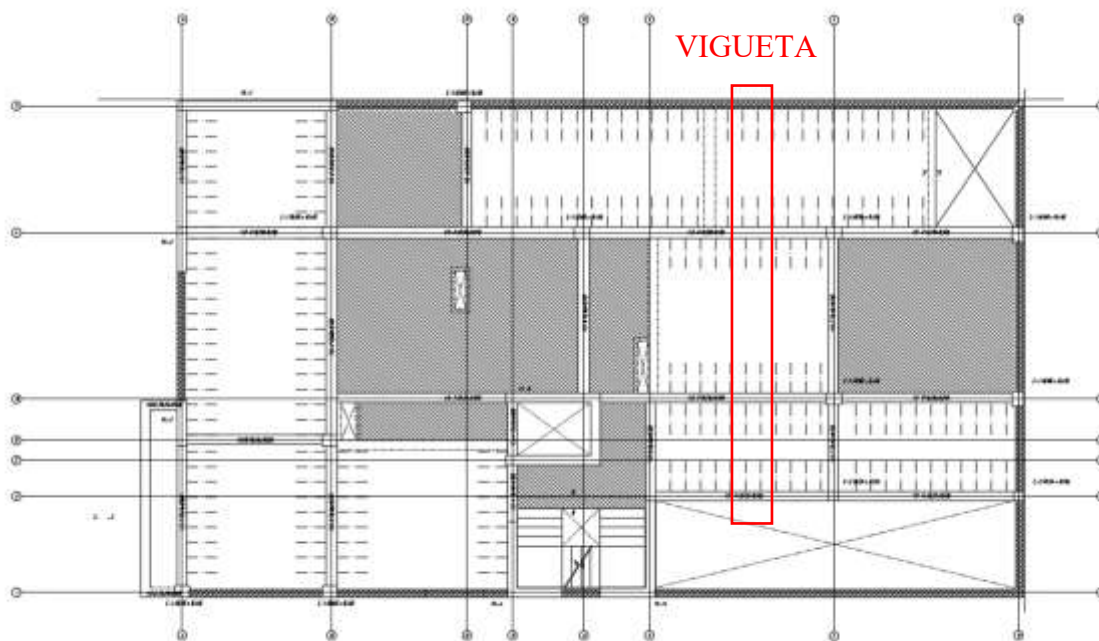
Ubicación en planta de las viguetas a diseñar
